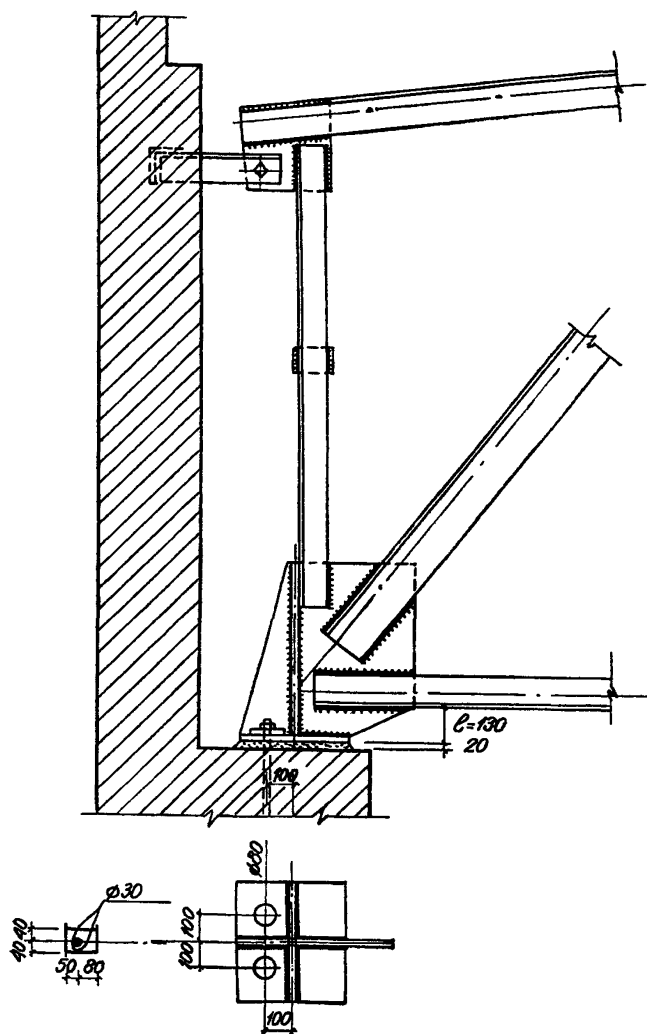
Опираие стропильной фермы на железобетонную колонну в однопролетном здании
